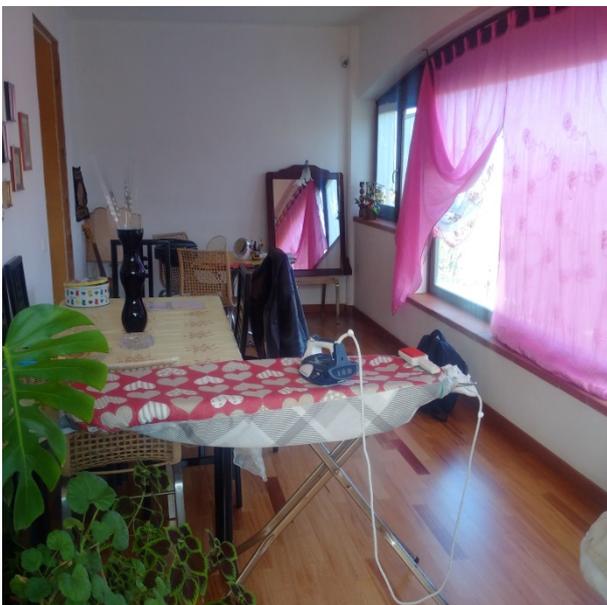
Loggiato verandato sul lato nord trasformato in vano abitabile attraverso la chiusura delle aperture ad arco tramite infissi.
